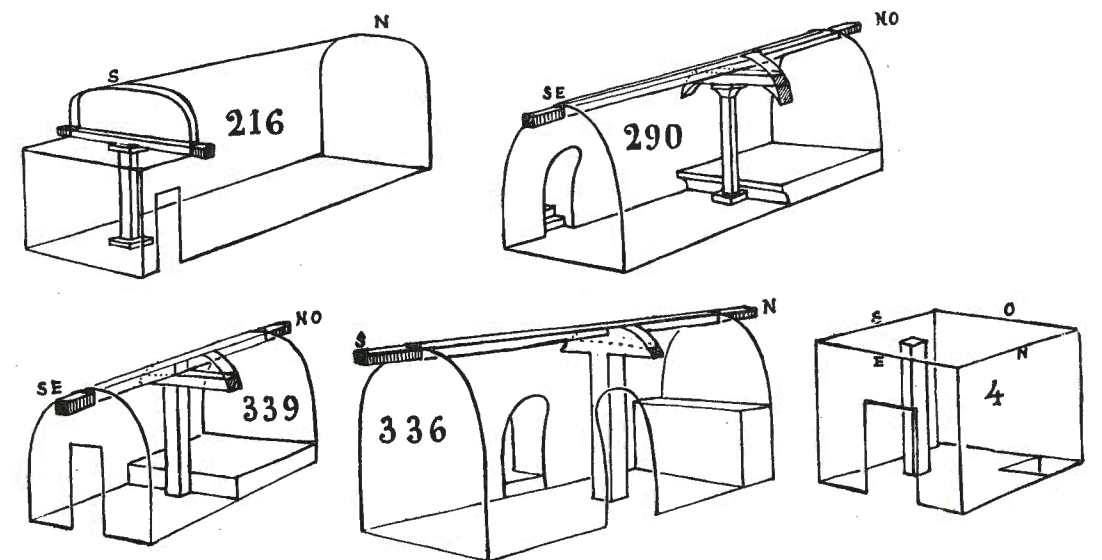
PILIERS DANS LES CAVEAUX ET POUTRES MAÎTRESSES ET TRANSVERSES.
